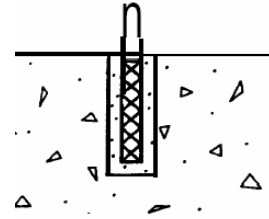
Taze Betona Yapılan Ankrajlar, (Gürbüz,2007).
